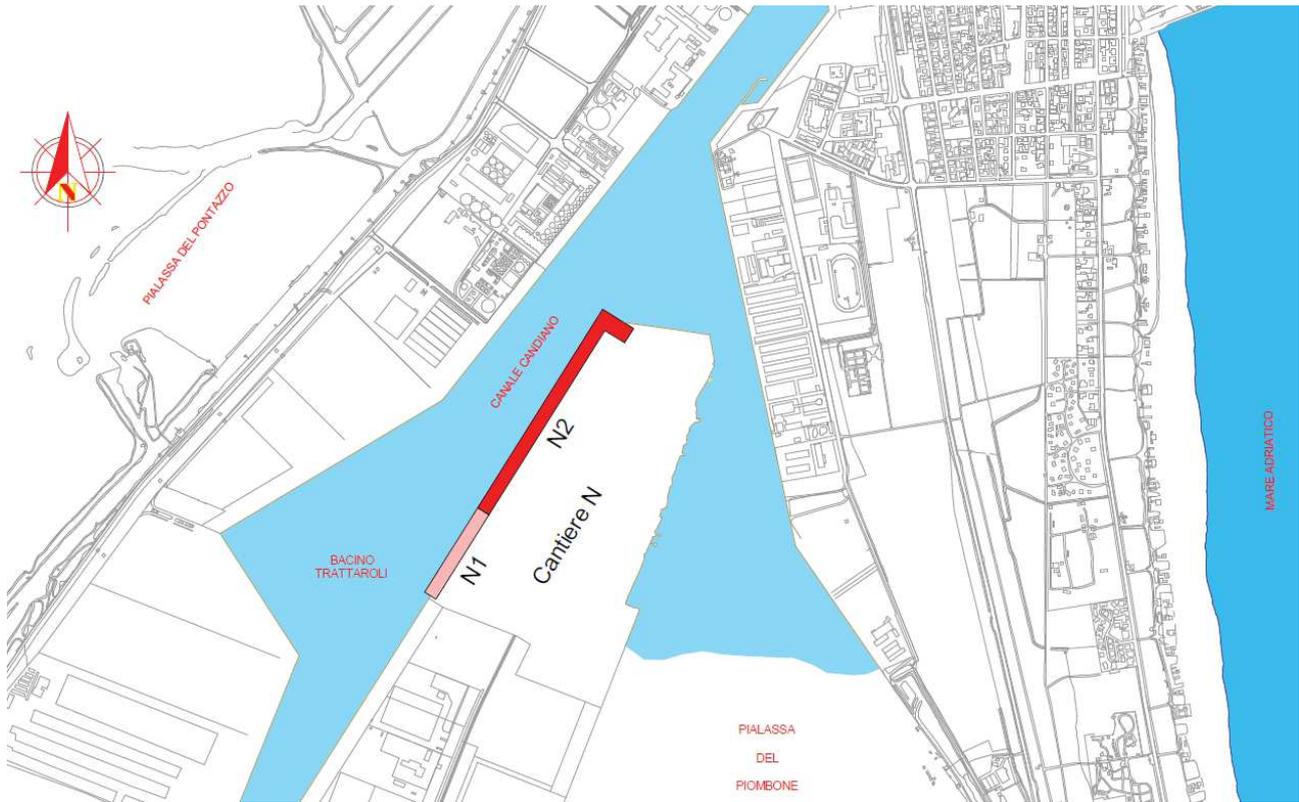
Schema planimetrico delle banchine oggetto di intervento
